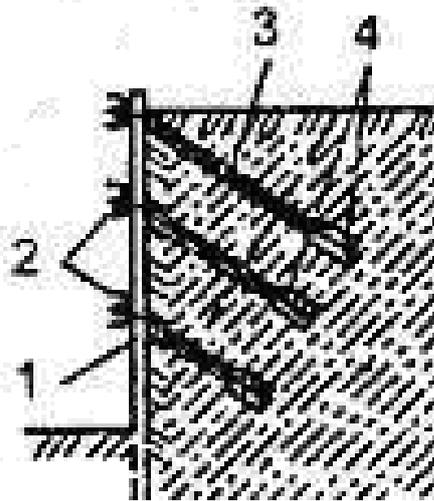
Шпунтовое ограждение стенки выемки с внутренним анкерным креплением для прокладки самотечного трубопровода из ПТ2сМ (ПТ2сГ): 1 - шпунтовая стенка; 2 – балки; 3 - тяги; 4 – анкеры
